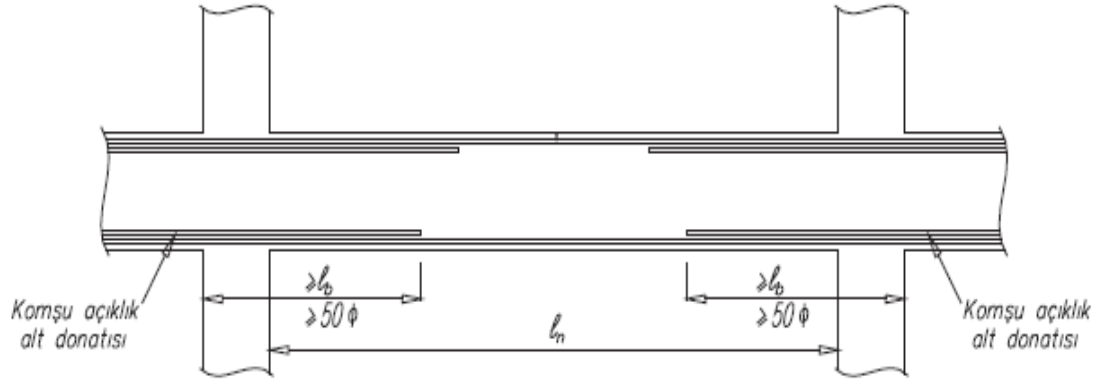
Kirişlerde boyuna donatının 90 derece kıvrılması şartına uyulmaması
